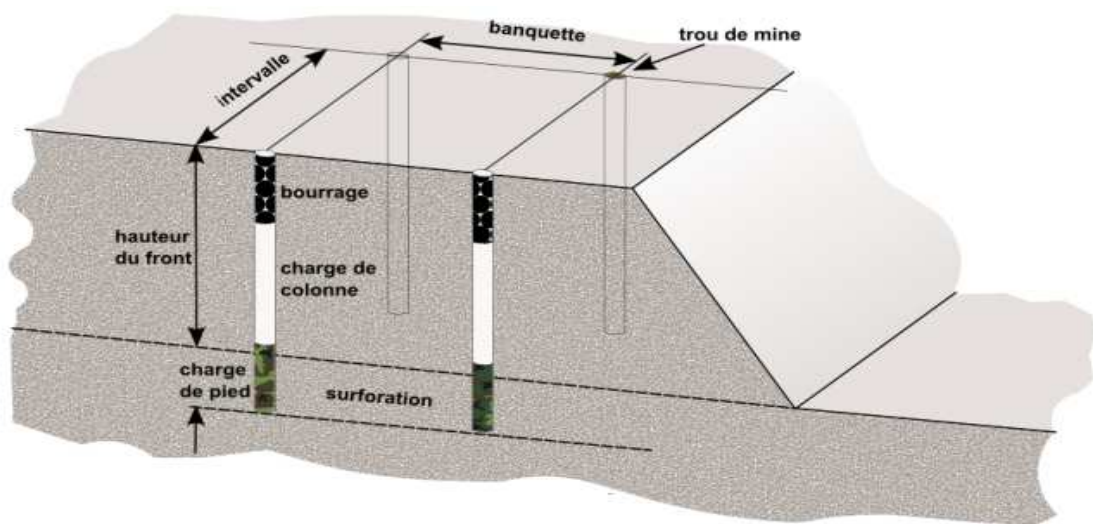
Paramètres géométriques d'un plan de tir [15]
